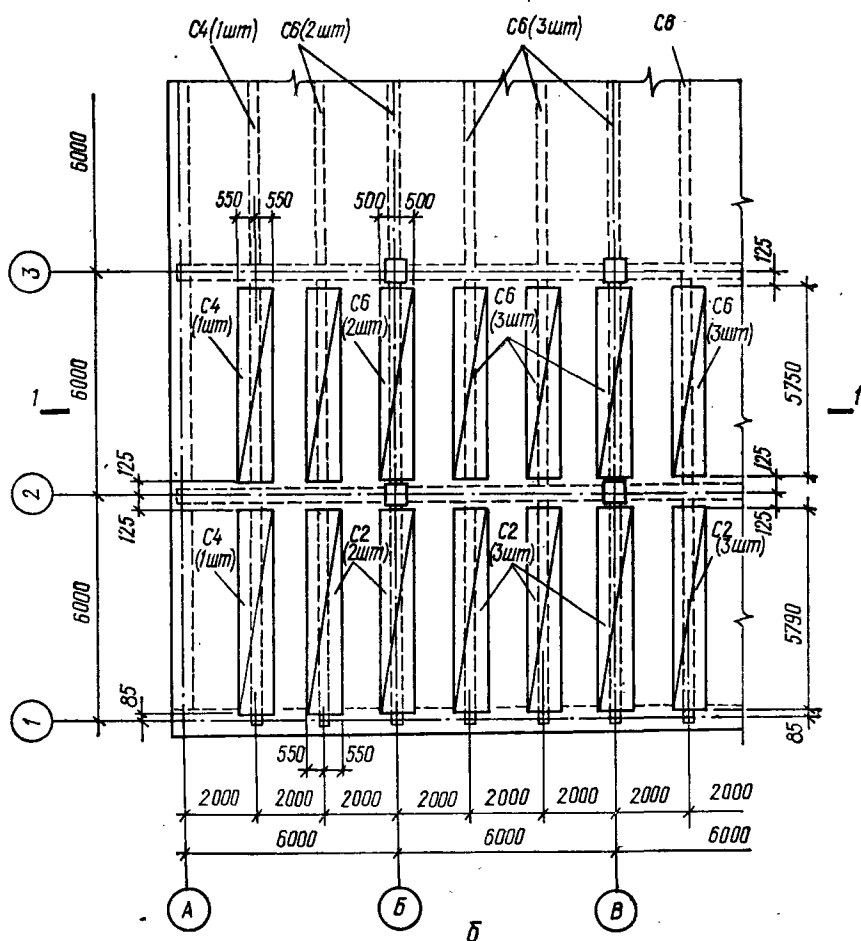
Армирование плиты сварными рулонными сетками с поперечной рабочей арматурой:
